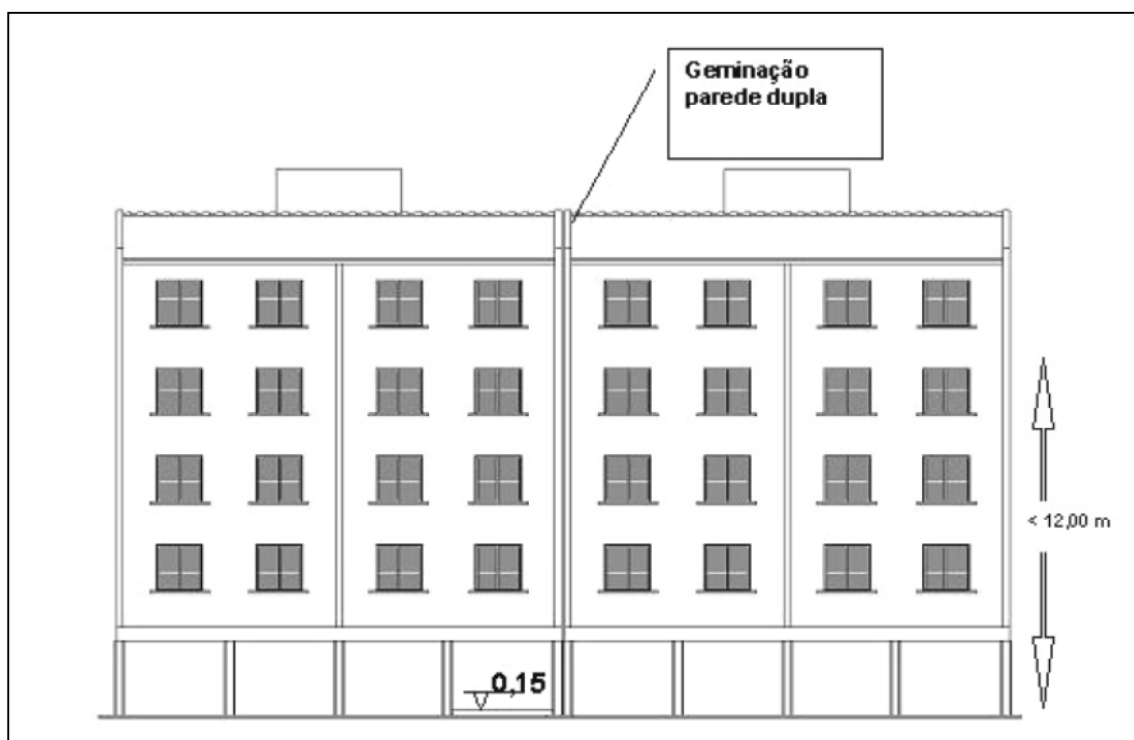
Edifício 05 pavimentos – Térreo Utilizado para convívio e estacionamento – Vista.
